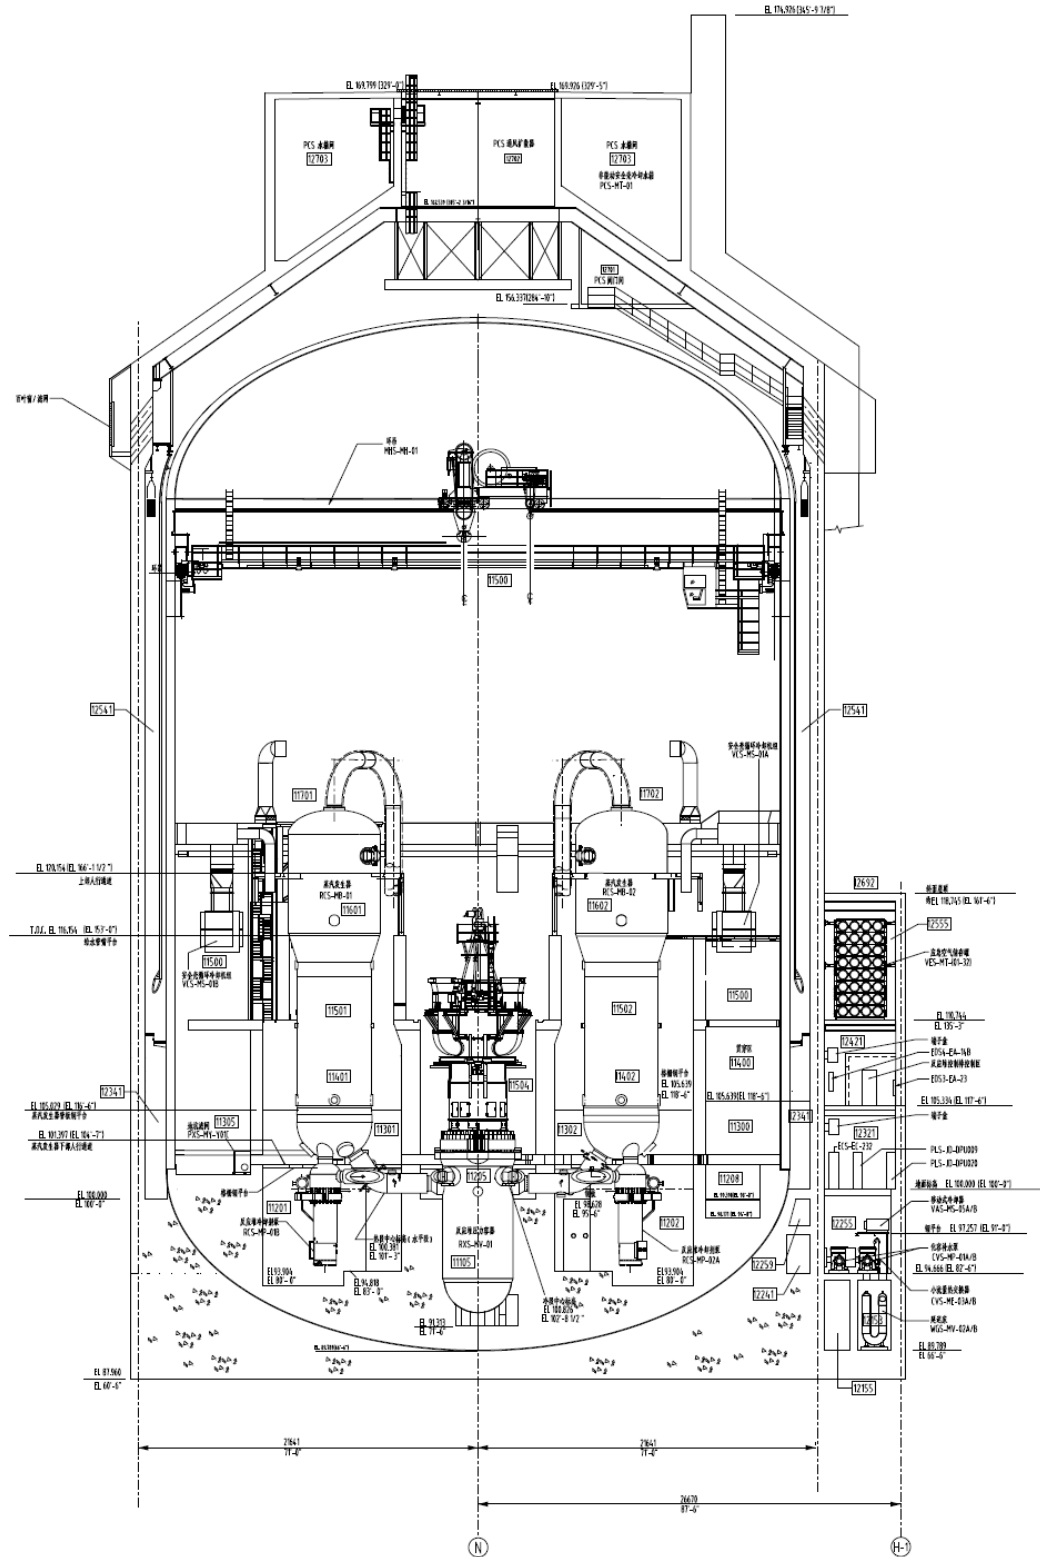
核岛厂房布置示意图 B-B 剖面
